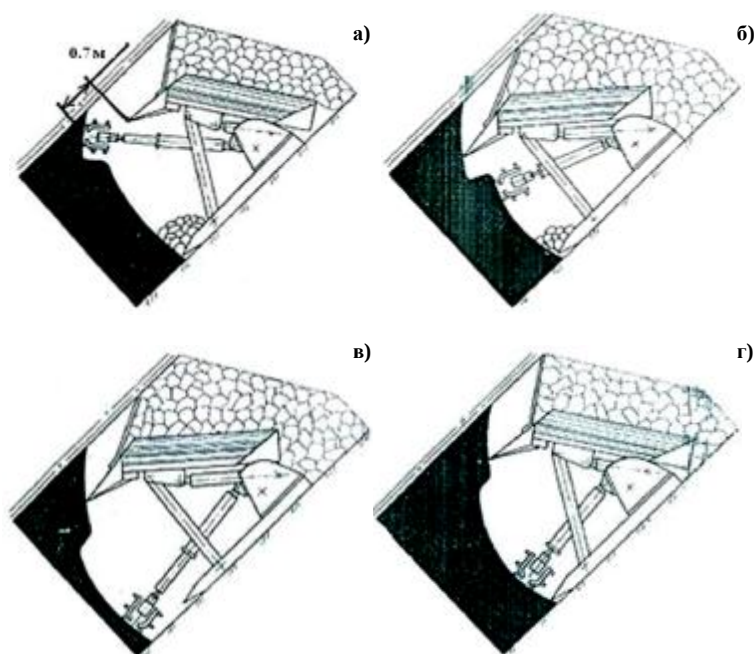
Схема обработки забоя (механизированная выемка: а) выемка подкровельной пачки; б) передвижка щитового перекрытия; в) обработка забоя и зачистка почвы; г) передвижка основания
